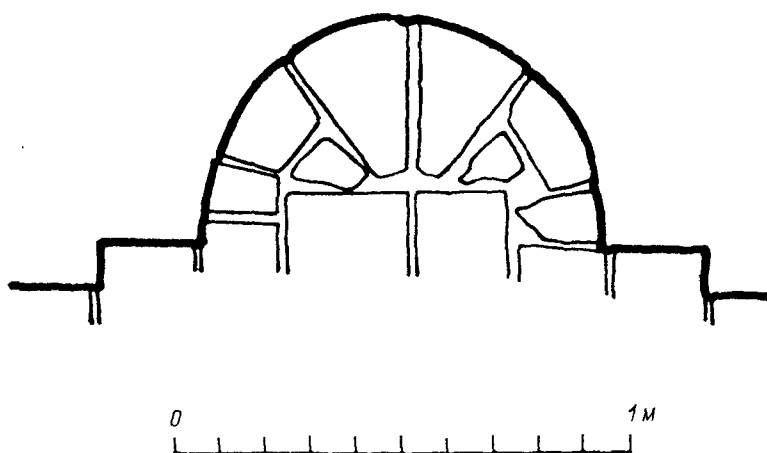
Выкладка фасадной полуколонны. Смоленск. Церковь Василия на Смядыни.
